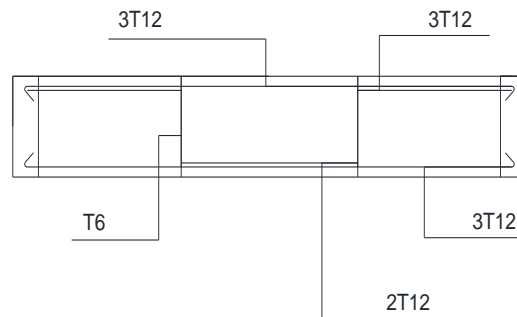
Coupe longitudinale d'une poutre noyée secondaire 20x30cm (plan irrégulier en élévation)
